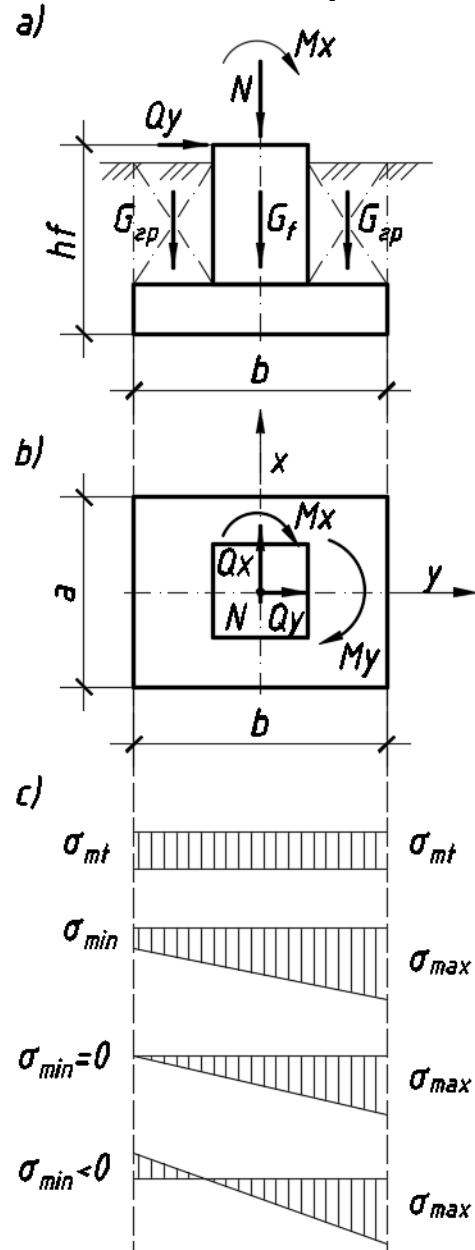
Навантаження, які діють на фундаменти: а) розріз фундаменту; б) план фундаменту; в) епюри напружень під підшвою фундаменту
